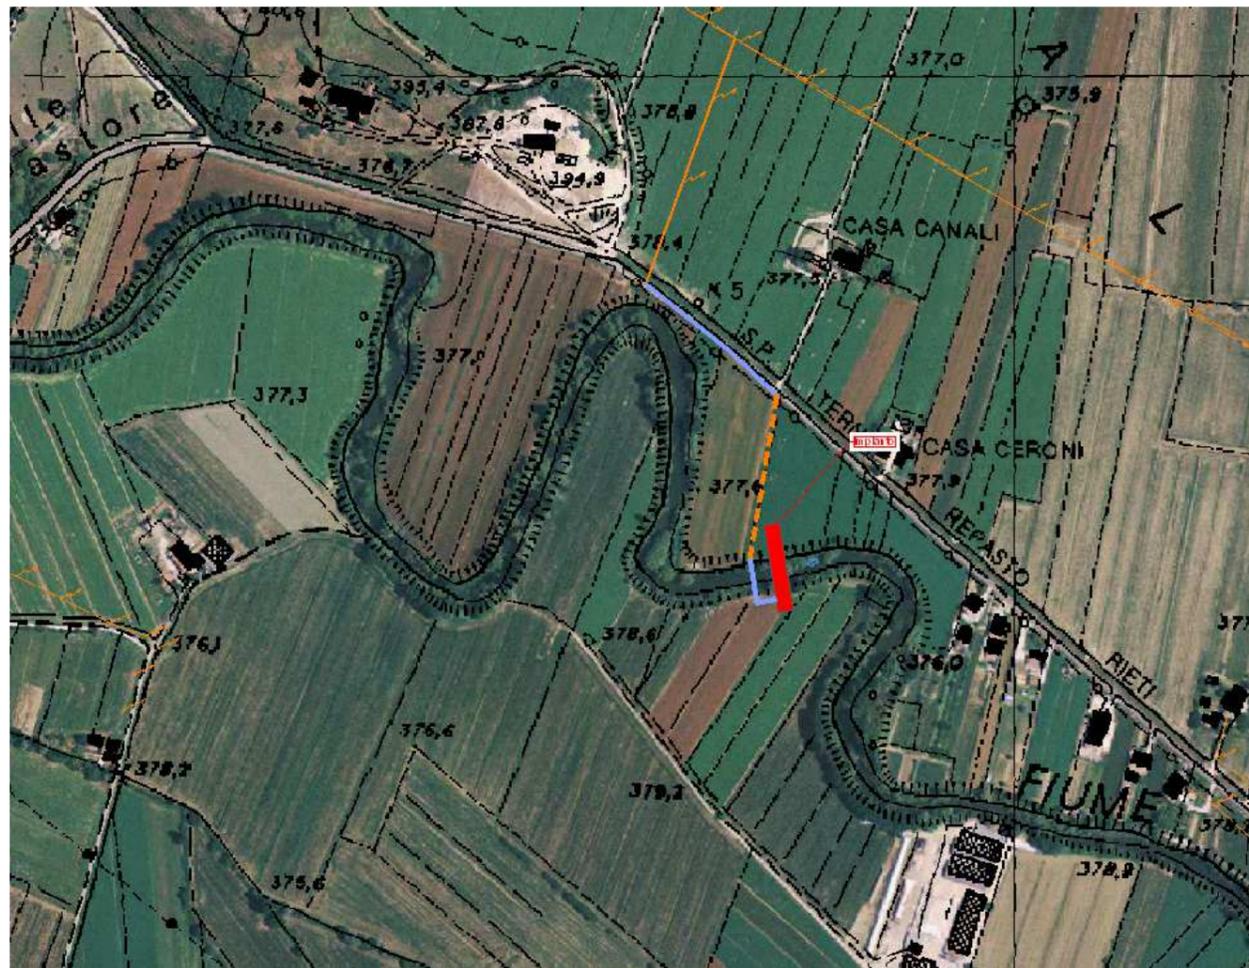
Planimetria della connessione elettrica alla rete esistente – base ortofoto
